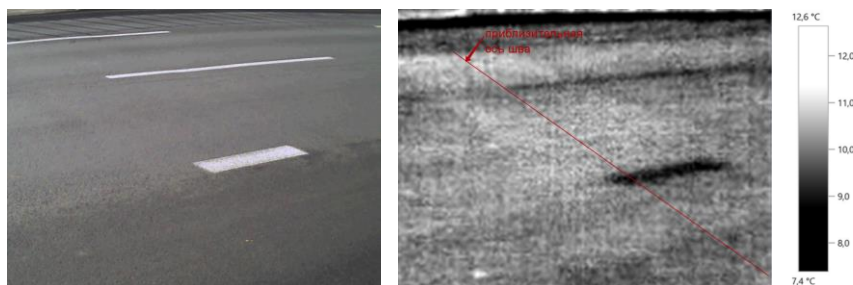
Экспериментальный деформационный шов, перекрытый железобетонной плитой. Возраст шва 1 год
